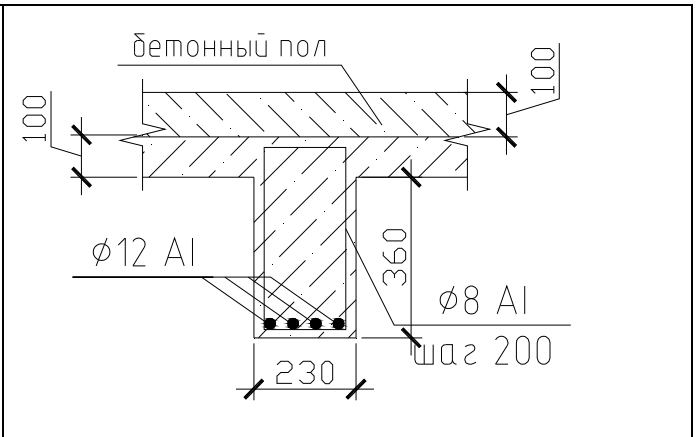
Второстепенная балка ж/б перекрытия над первым этажом
